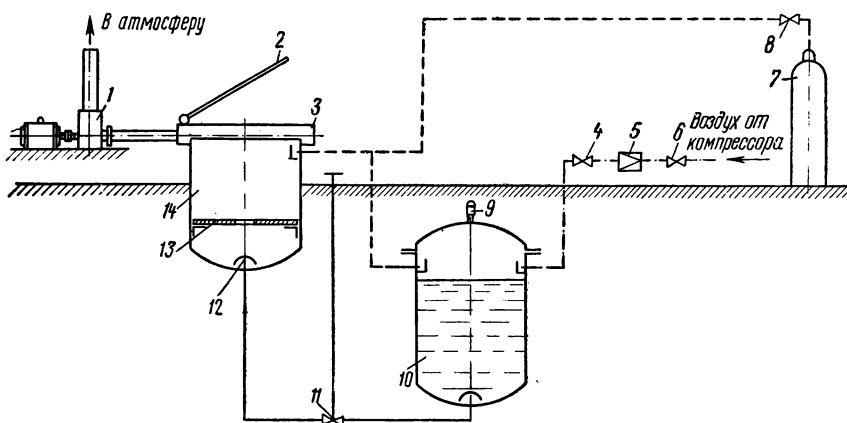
Схема установки для пропитки изоляции обмоток якорей погружением в лак: 1—вентилятор с электродвигателем; 2—крышка; 3—бортовой отсос; 4, 6 и 8—вентили; 5—редукционный клапан; 7—баллон с жидким азотом; 9—предохранительный клапан; 10—лакохранилище; 11—запорный вентиль; 12—фильтр; 13—подставка; 14—пропиточный бак
